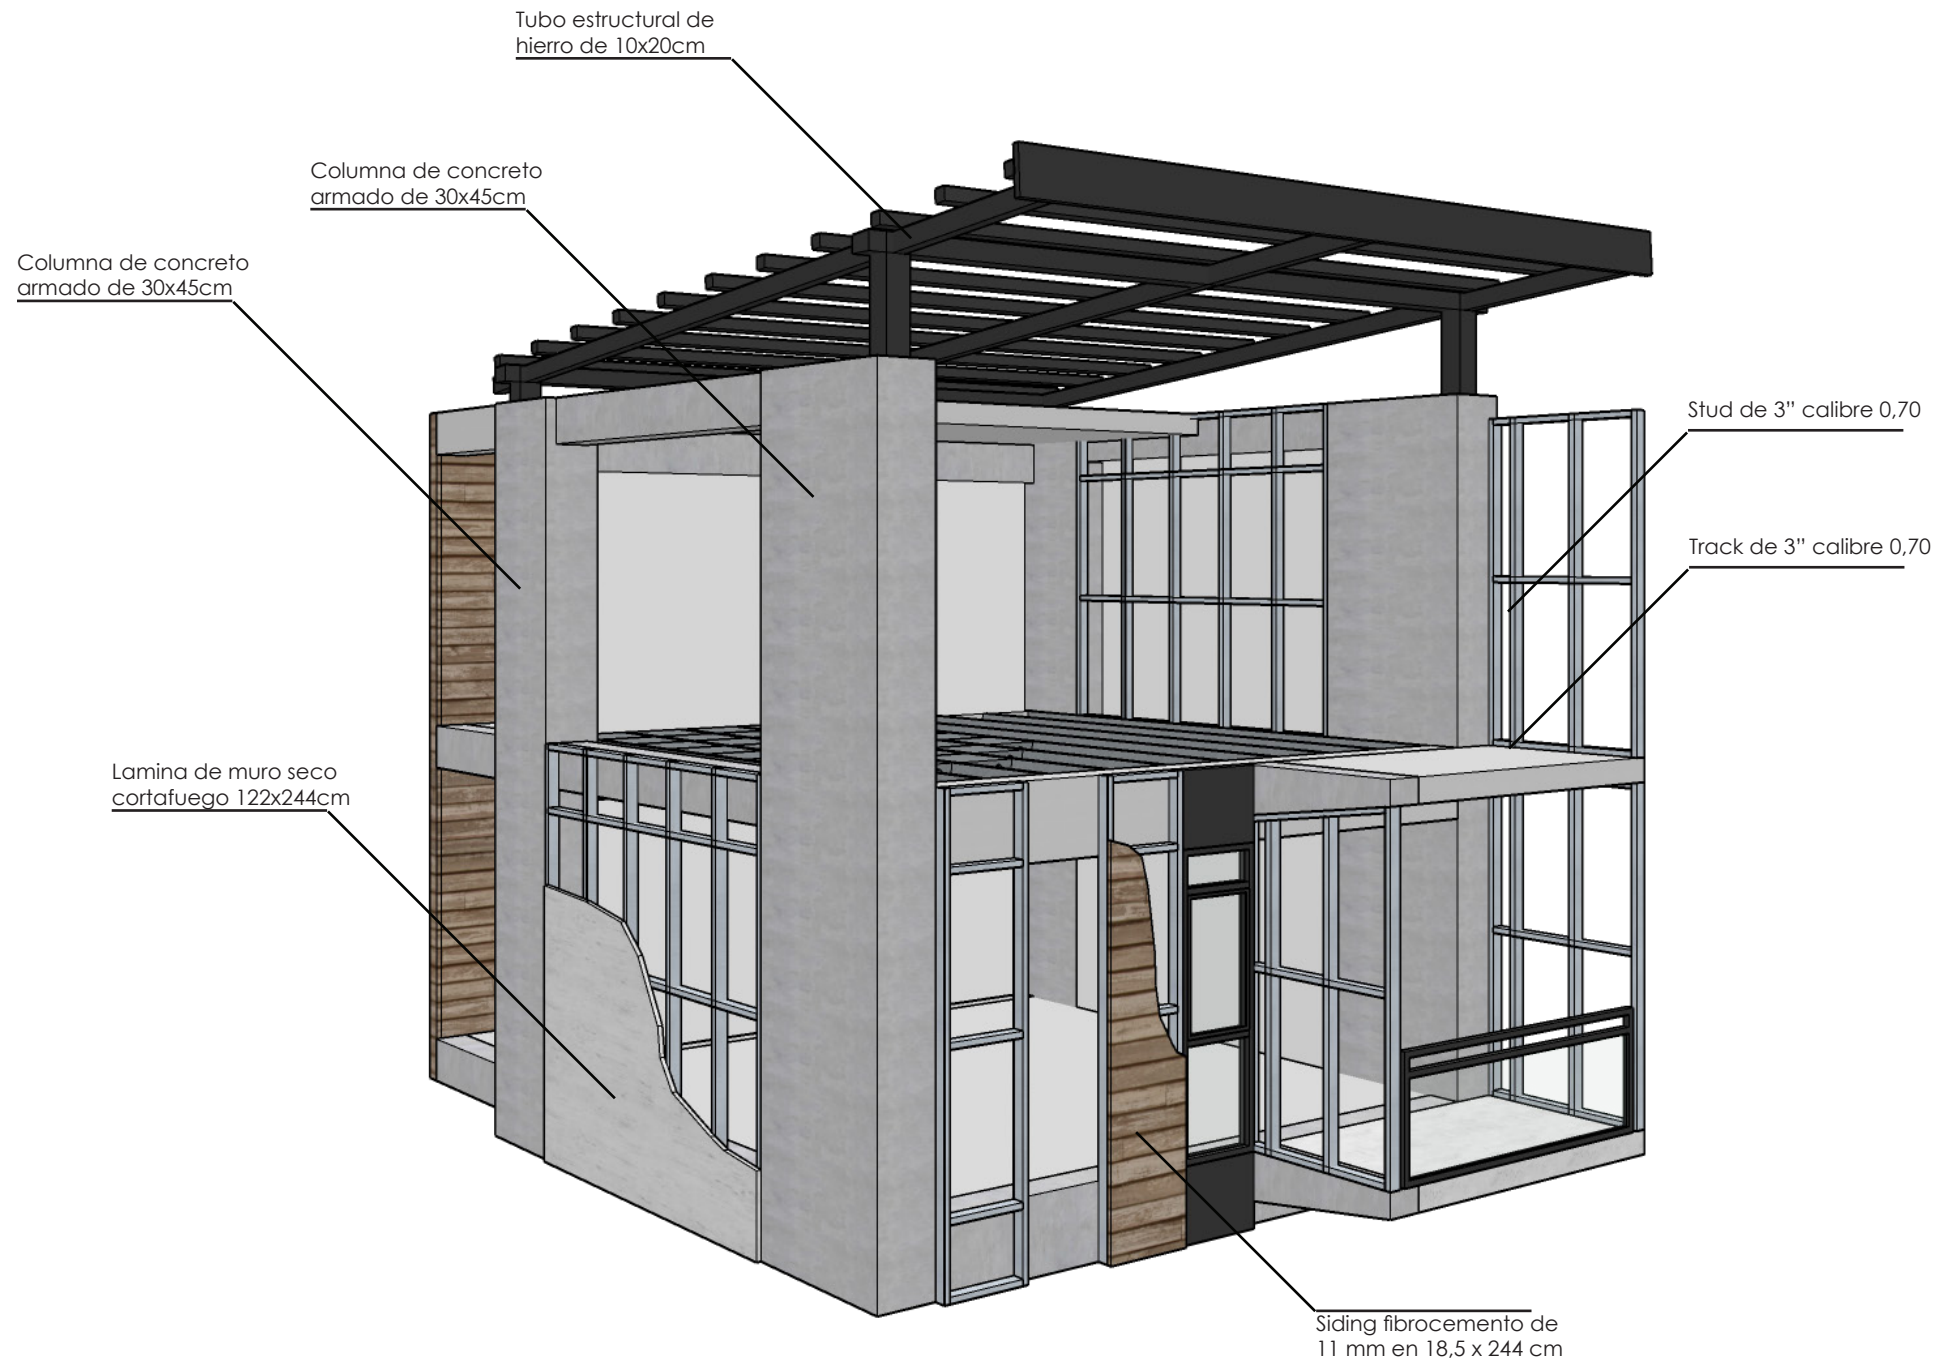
Detalle estructural unidades habitacionales. Fuente: Elaboración propia.
